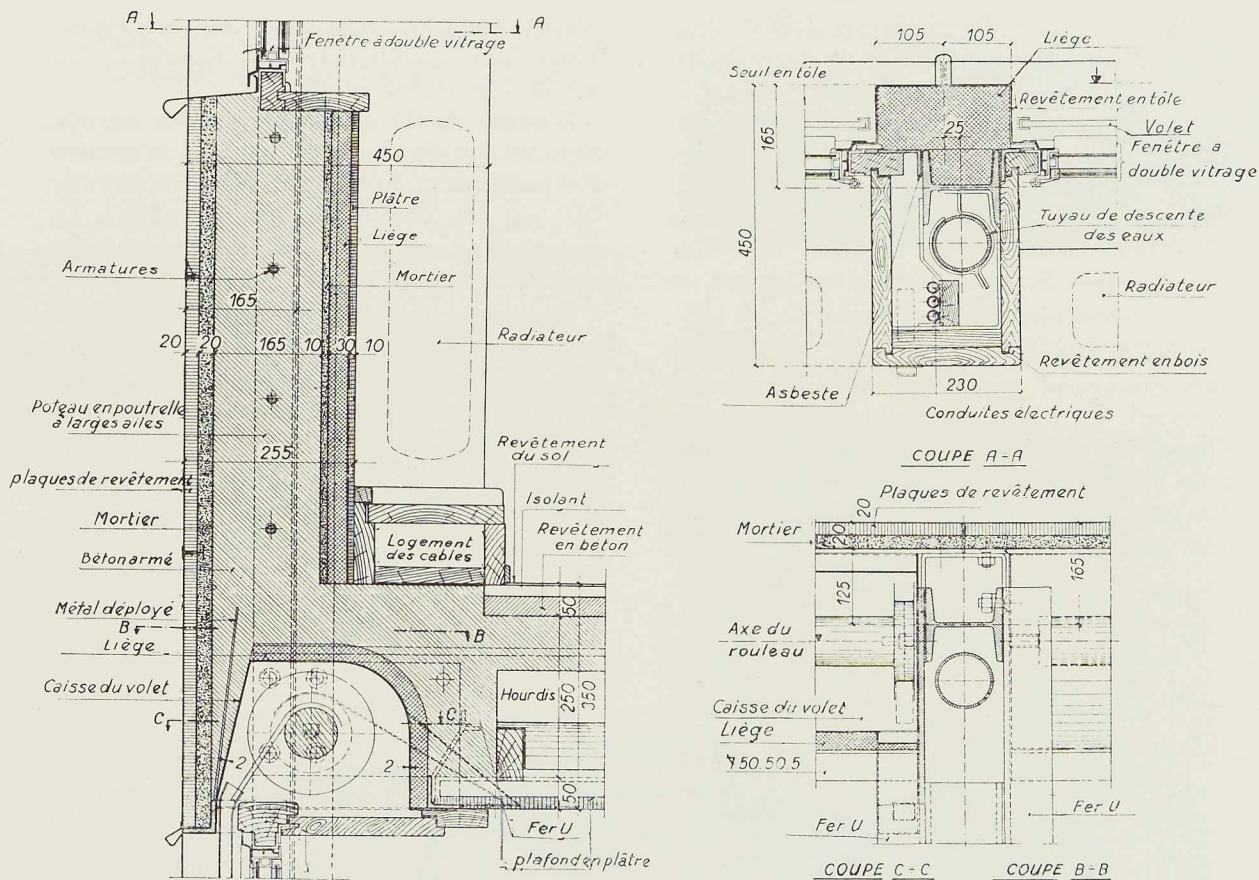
Coupes verticale et horizontales d'un mur, montrant notamment la disposition des canalisations.
